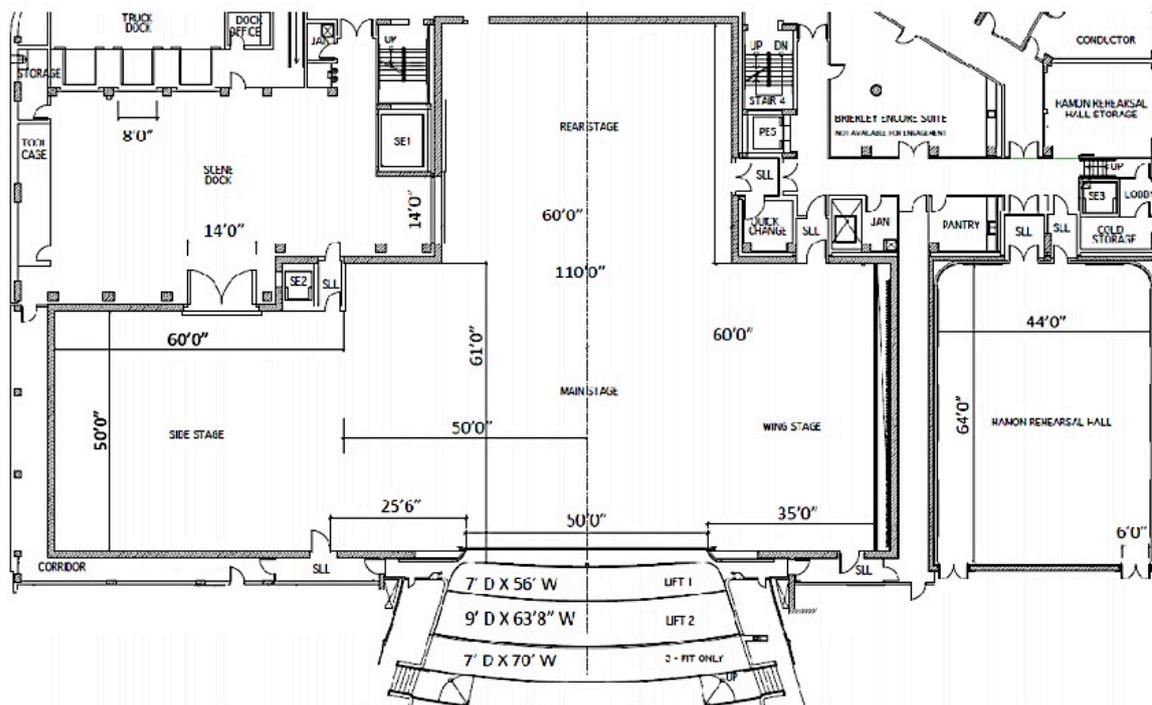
Planta do palco. (FONTE: ATTPAC,2012. NOTA: dimensões em pés)
